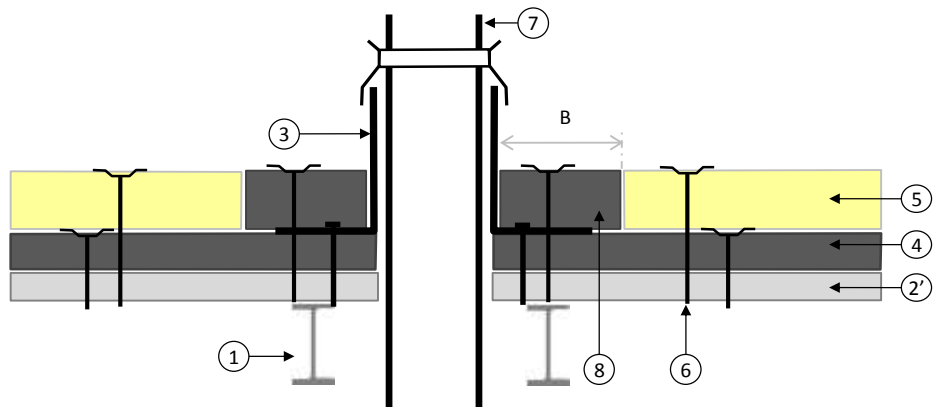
d – Calfeutrement des conduits avec fourreau rapporté sur bois
